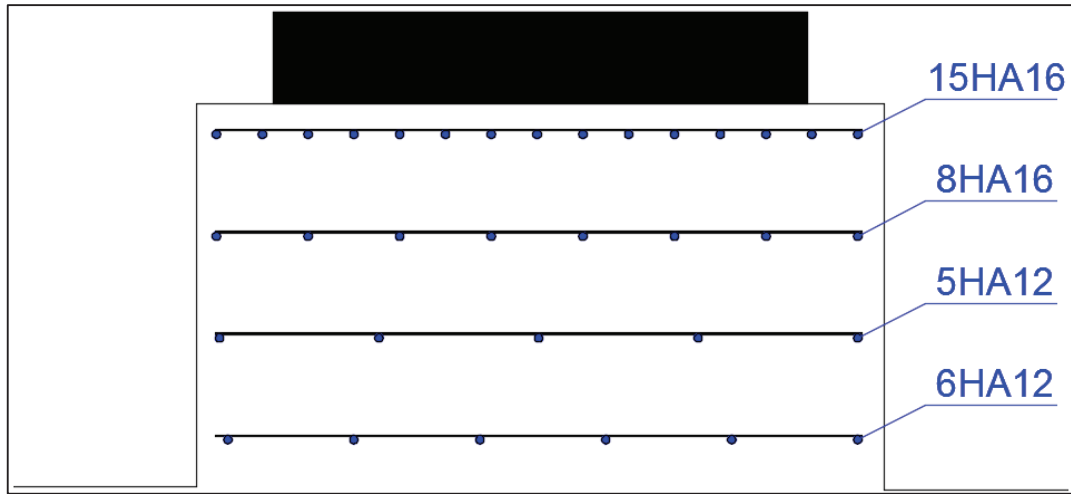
Ferrailage du dé d'appui au niveau de la pile.
